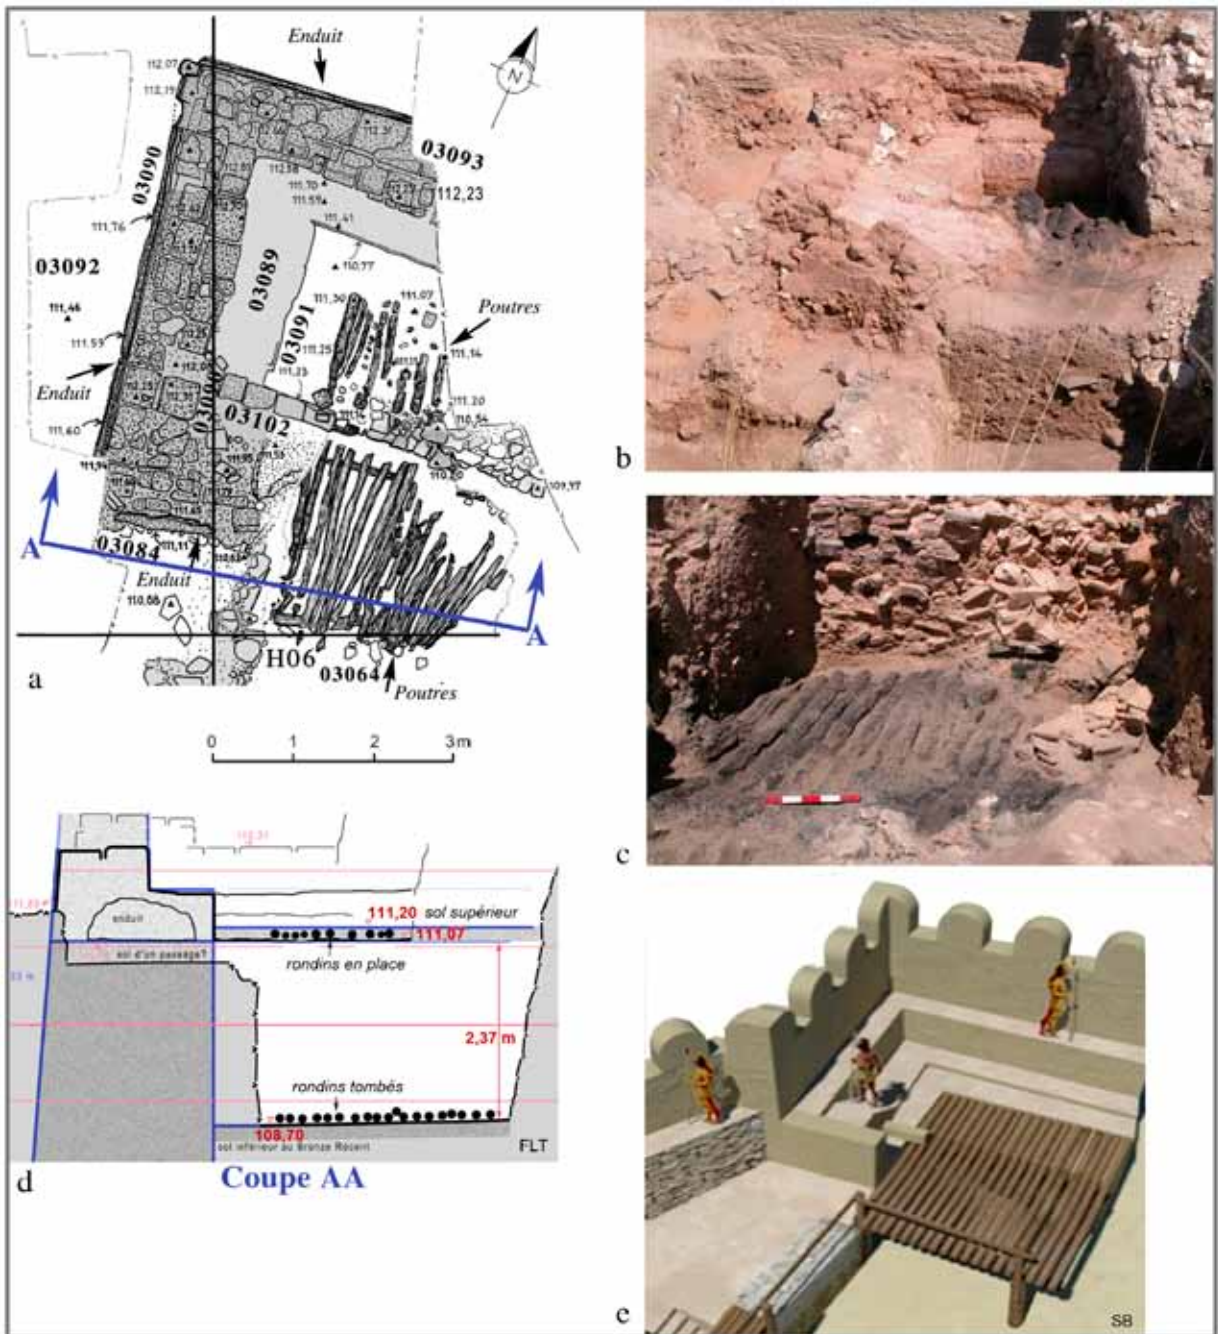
Le plancher de la Tour Nord : a. Plan d'ensemble ; b. Partie haute *in situ* dans la tour (cliché A. Tibet 2007) ; c. Partie de plancher tombée sur le sol (cliché A. Tibet 2008) ; d. Coupe restituant la hauteur du plancher ; e. Modélisation du plancher.
